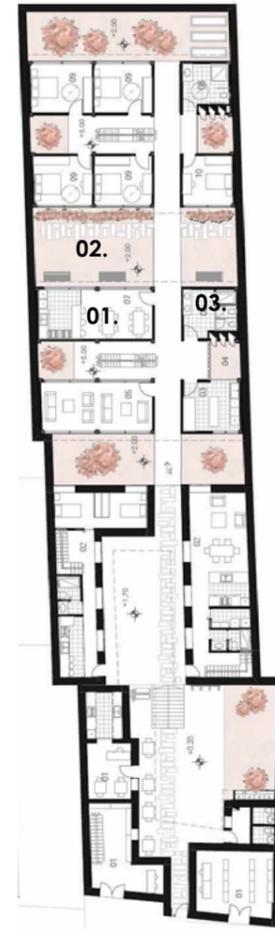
planta ubicación zonas comunales Fuente: Elaboración propia
